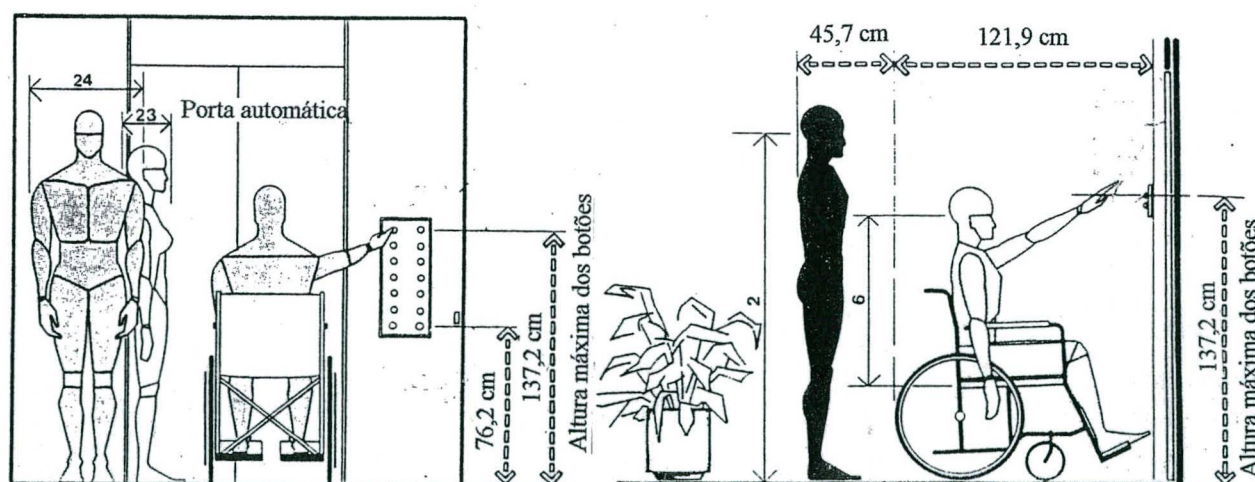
Configuração Aconselhada para os Elevadores.
